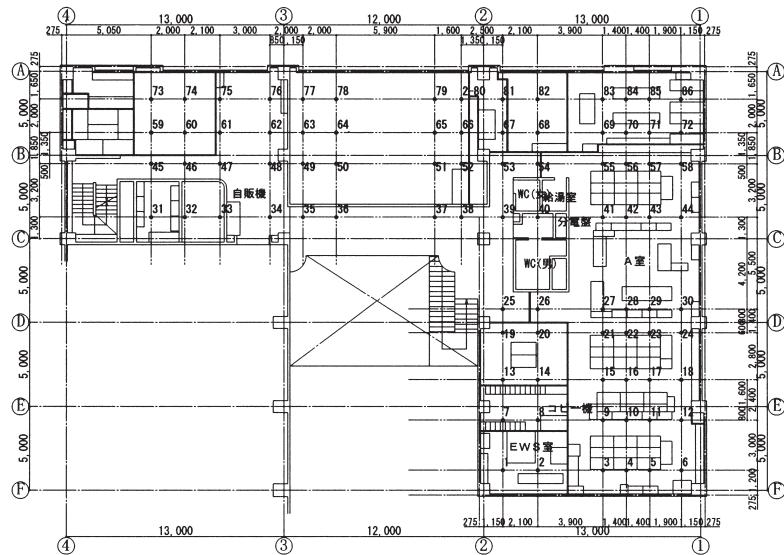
環境磁場の計測位置（平面図）2階 計測点数86
